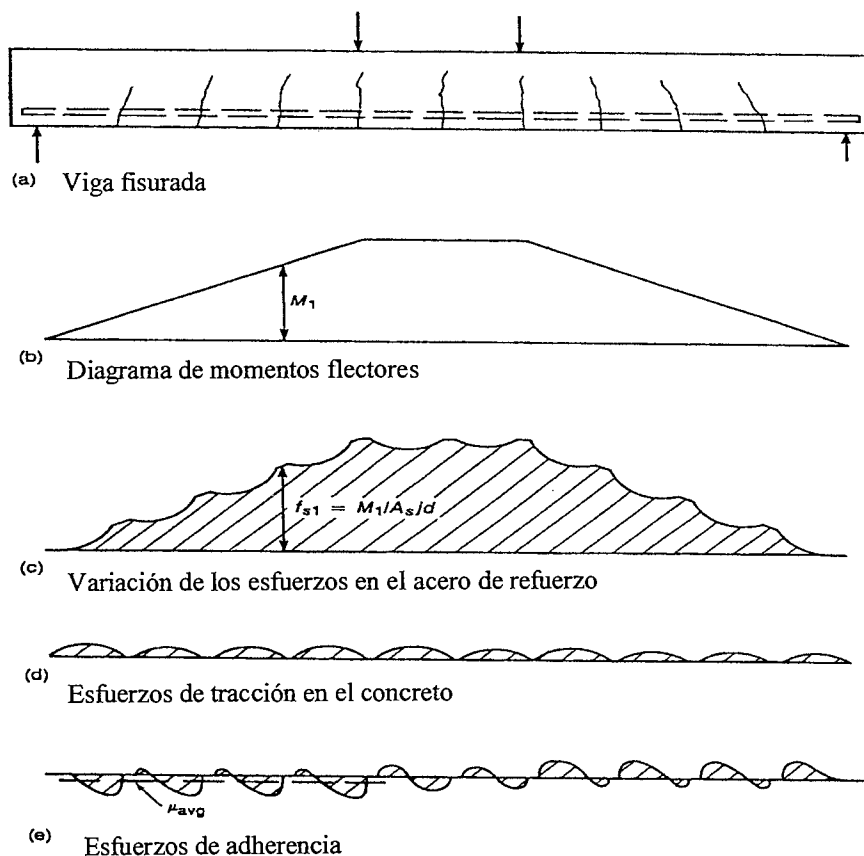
Variación de los esfuerzos de adherencia en una viga fisurada
